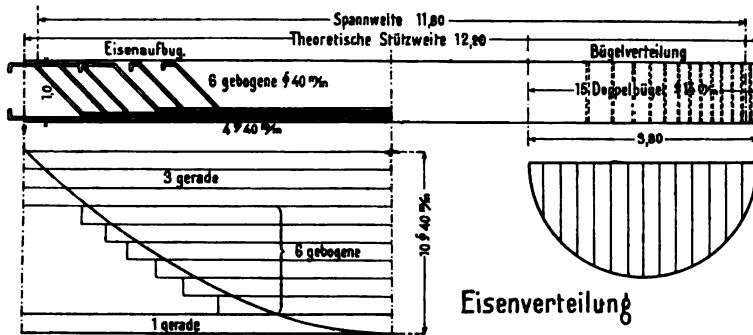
Eisenverteilungsplan für die Eisenbetonkonstruktion des Stallgebäudes in Baden bei Wien.
